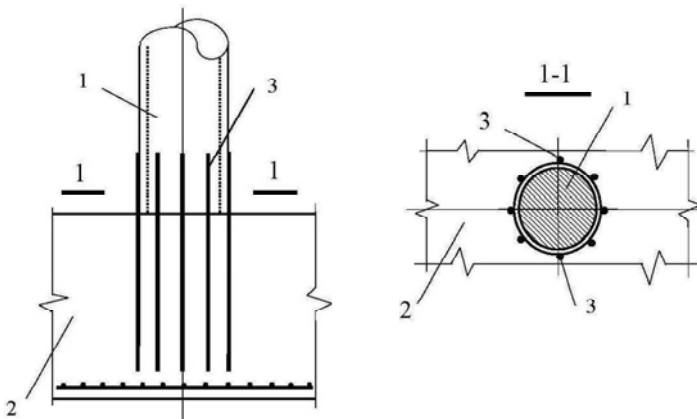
Вузол з'єднання трубобетонної колони з залізобетонним фундаментом за допомогою анкерних стержнів: 1 – трубобетонна колона; 2 – залізобетонний фундамент; 3 – анкерні стержні
